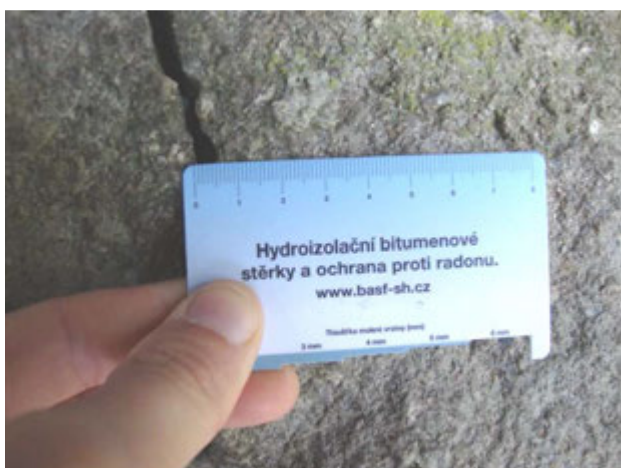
Degradované povodní křídlo levobřežní opěry.
